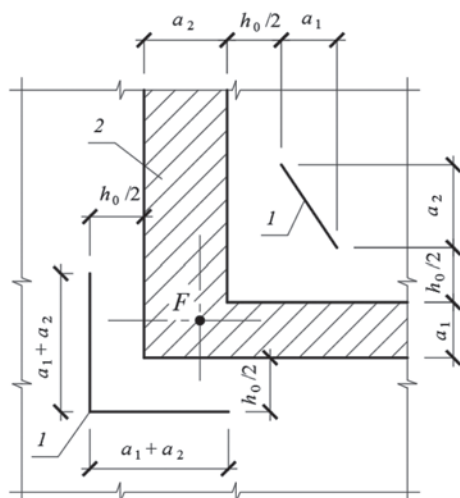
Схема расчетных контуров поперечного сечения при продавливании плоских плит около углов стен:
